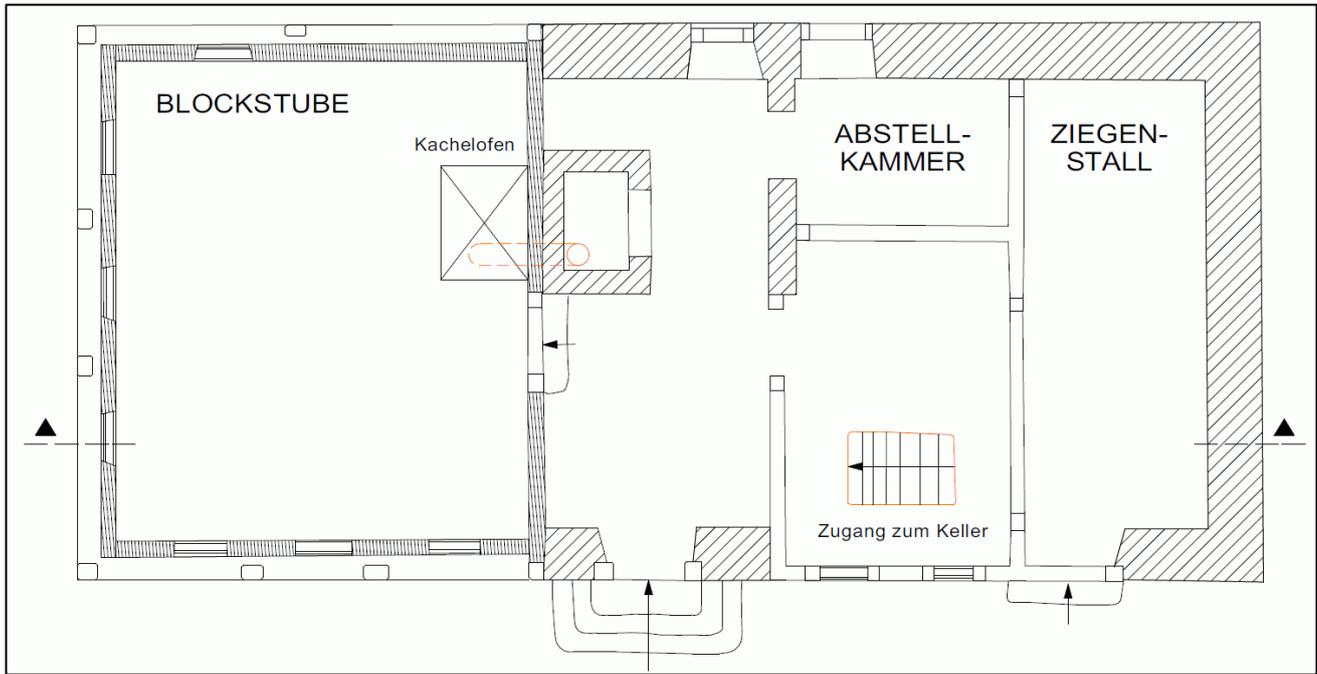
Anordnung Abluftanlage, Grundriss
